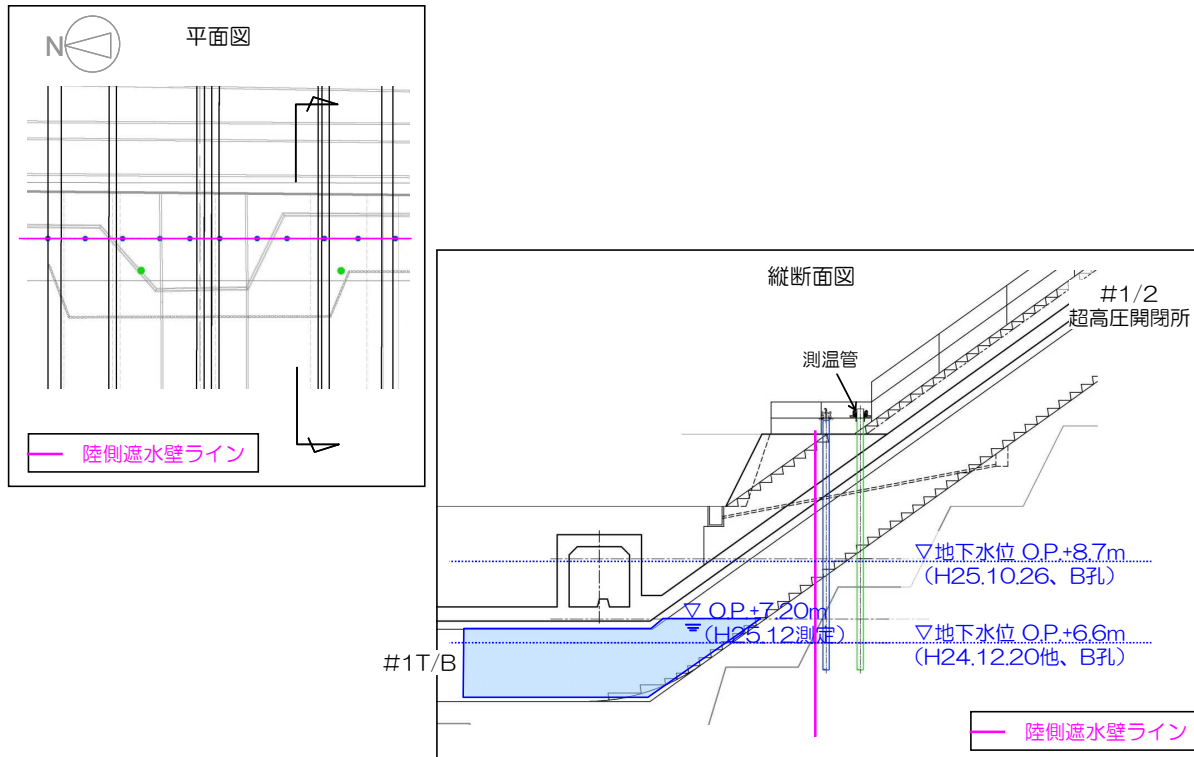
【5-1】1号機電気ケーブルダクト 施工方法（貫通施工）
